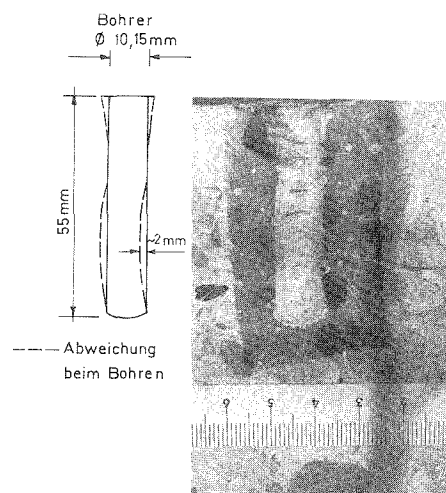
Bohrlochgeometrie. Erstellung des Bohrloches mit einem Hammerbohrer Ø 10 mm (Hartmetallschneiden Ø 10,15 mm) Beton B 25
